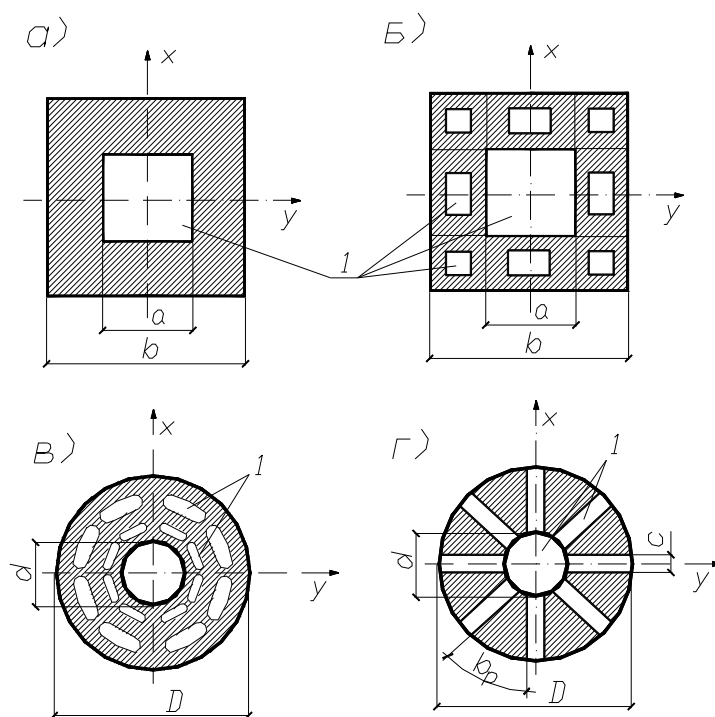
Форми підосви фундаментів *а, б* – переривчато-квдратні фундаменти; *в, г* – переривчато-кільцеві фундаменти
